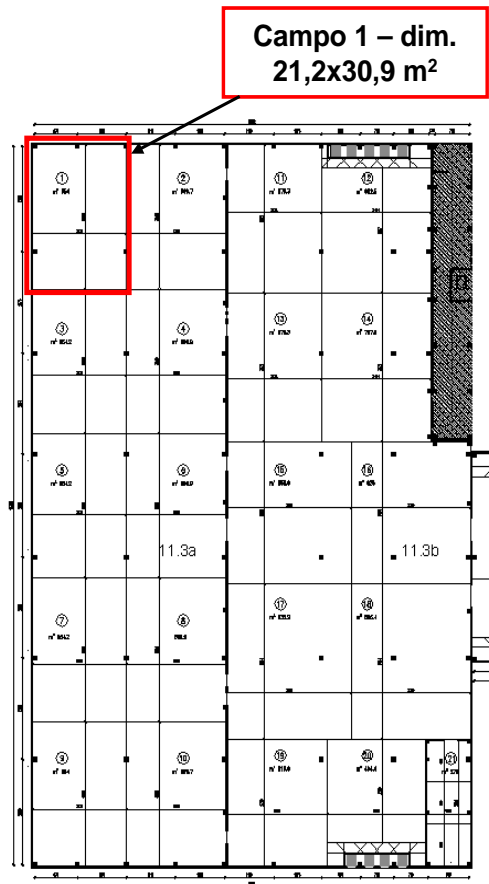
Pianta della pavimentazione oggetto studio; in evidenza il campo di pavimentazione (Campo 1) considerato nell'ambito dello studio numerico svolto.
